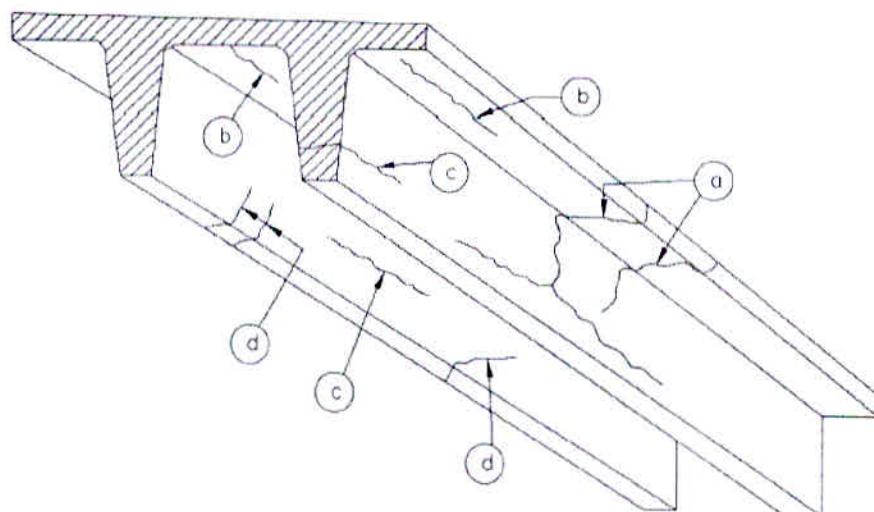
Patologias de causas físicas na laje e nas vigas.
